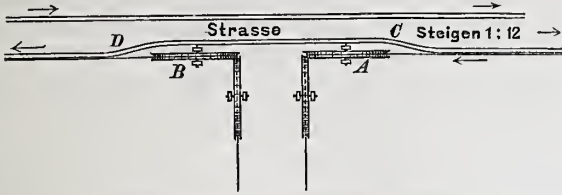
Einführung des Kabels in das Maschinenhaus. Grundriss.
